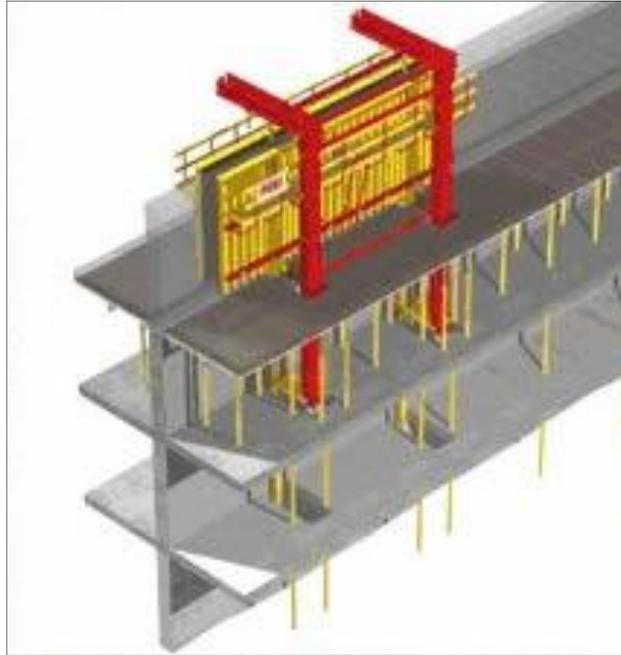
Sistema de encofrado autotrepante para hormigonado de muros.
